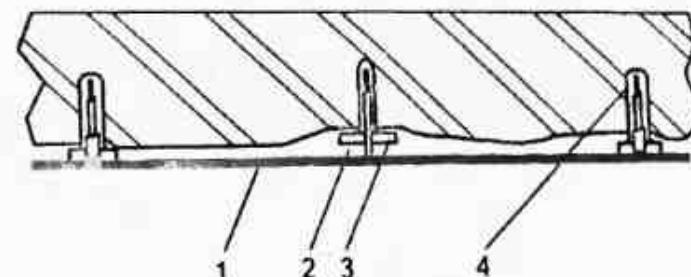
Крепление панели к обрешетке: 1 – стеновая панель; 2 – деревянная рейка; 3 – деревянная прокладка; 4 – дюбель
